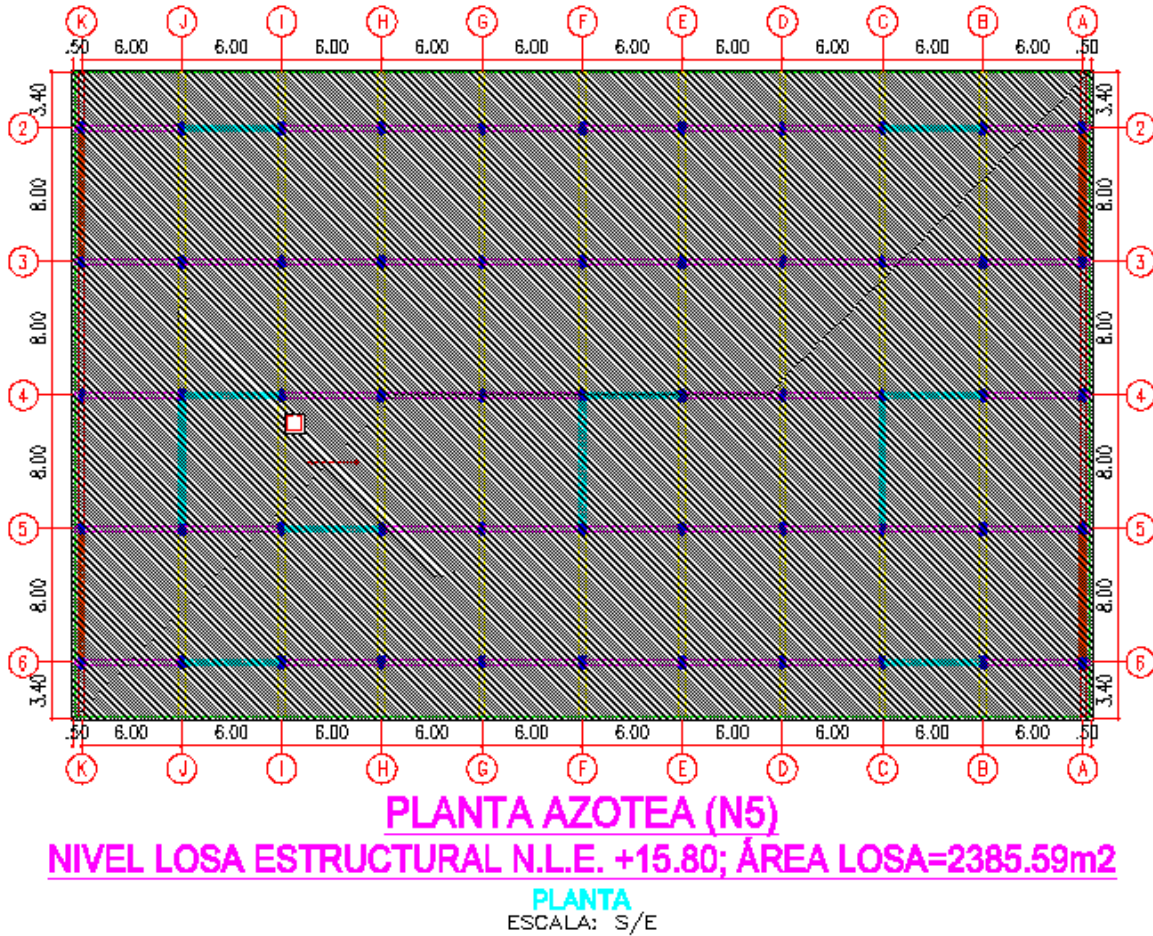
Planta quinto nivel – N.L.E. +15.80m – área de losa (diafragma)=2385.59m²
